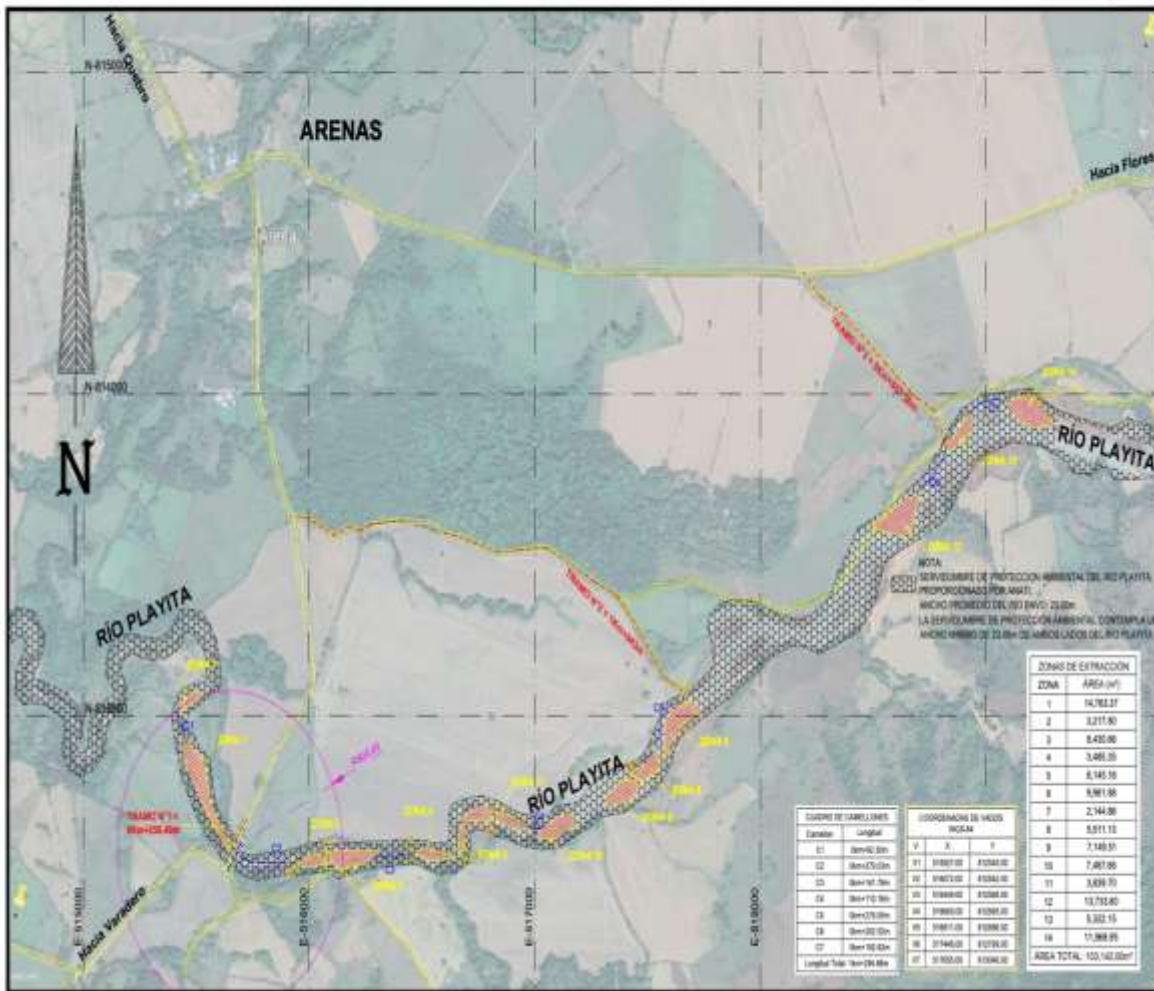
Extracto (sin escala) del plano denominado Ubicación de las Zonas de Extracción del Río Playita. Plano de referencia en escala mayor, en Anexo 2. Fuente: Google Earth.
